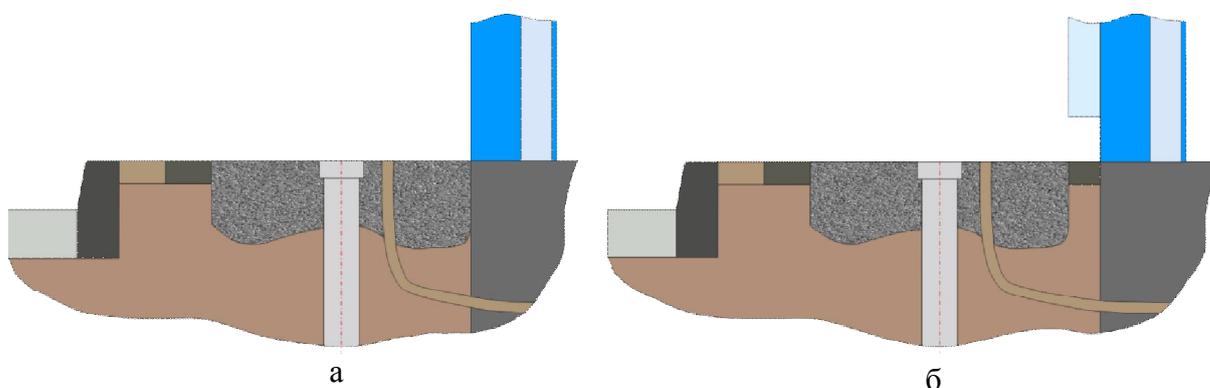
Схемы заливки фундамента при различной облицовке здания АЗС
